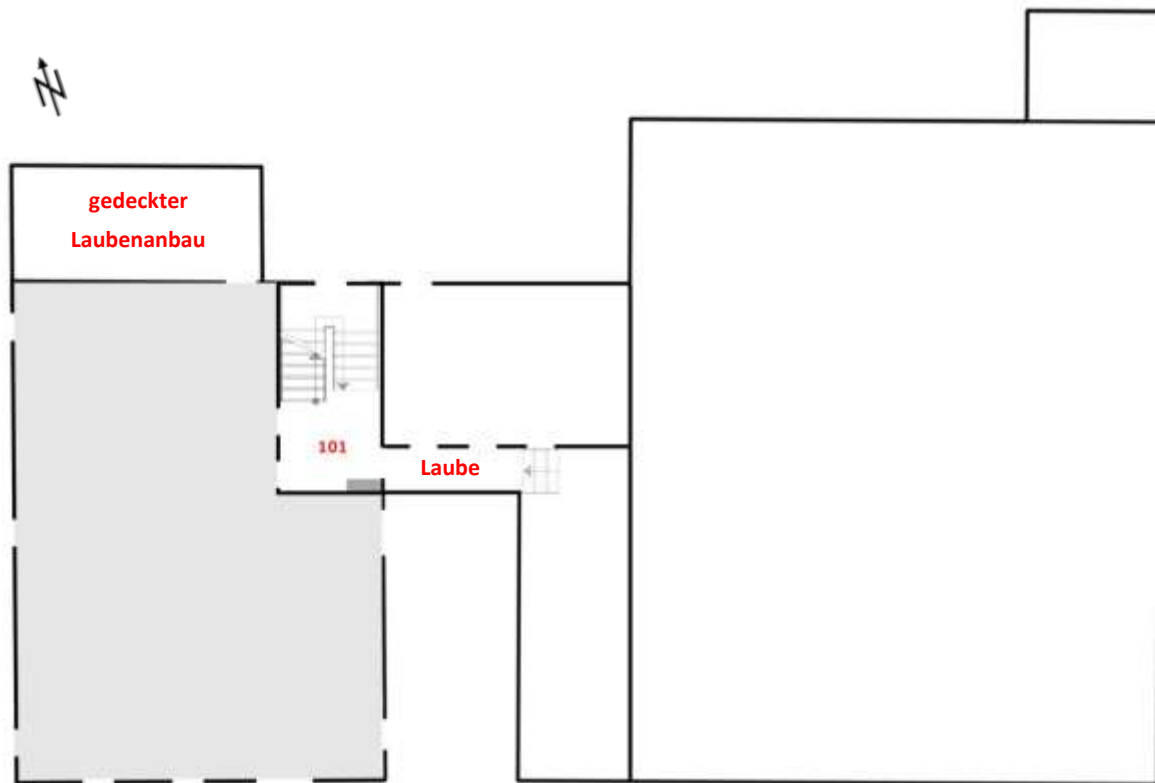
Schematischer Grundriss 1. Obergeschoss. Bearbeitung IBID.
